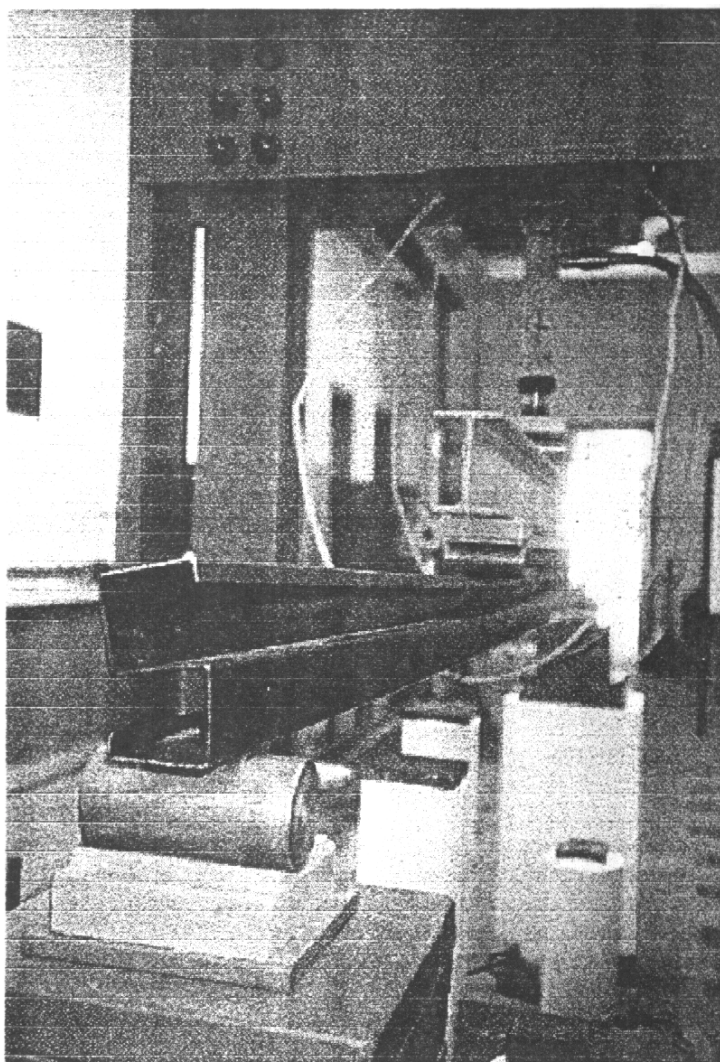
Perfil M21AC: distorção da seção sobre apoio.
